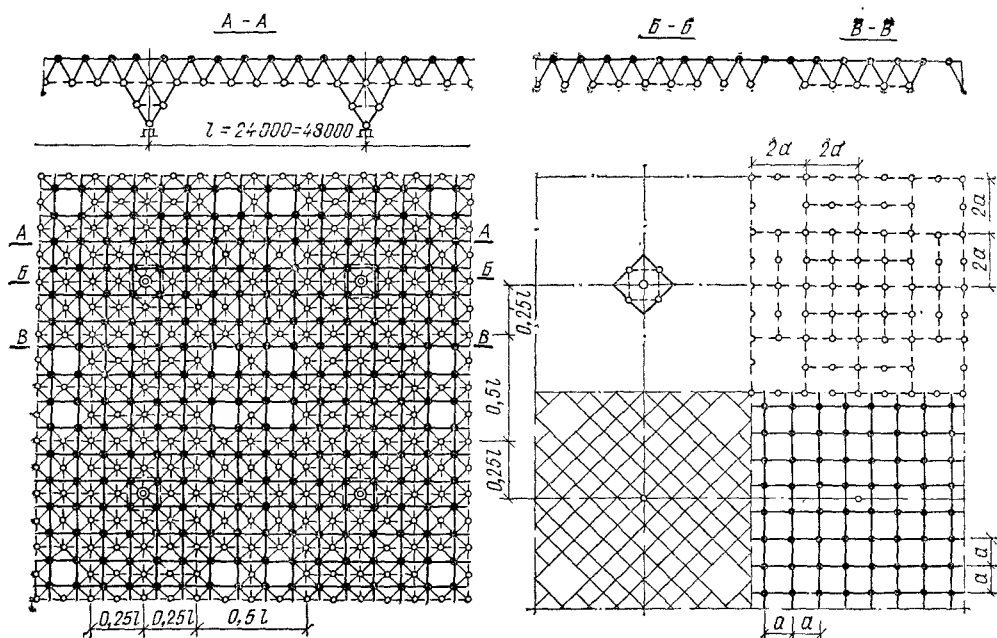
Фрагмент безбалочного структурного покрытия многопролетного здания
